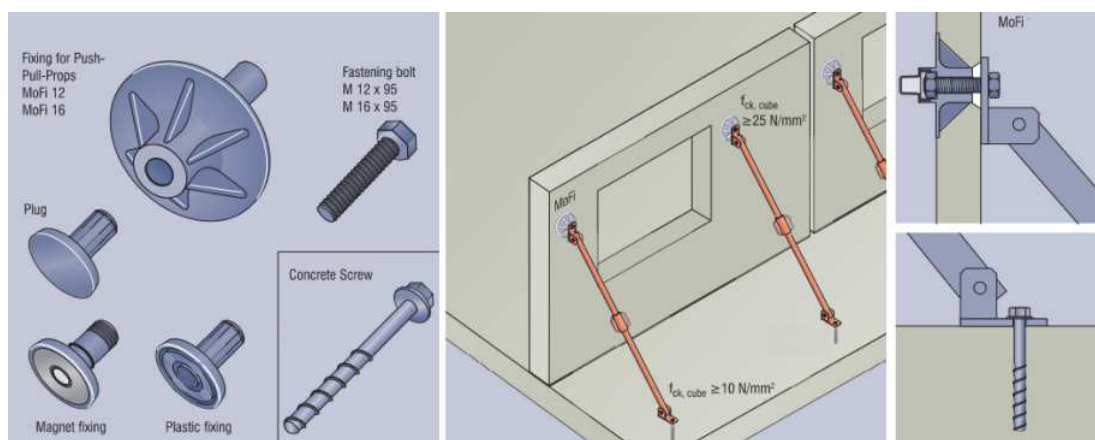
Tvar hlavních kotvících prvků systému PCC [5]
